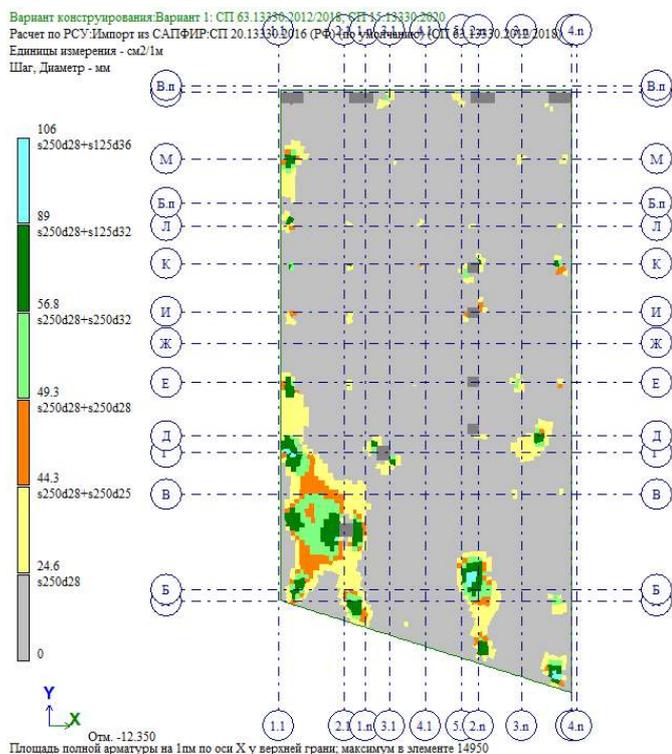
Армирование плиты по оси X у верхней грани (на 1 м.п.)
